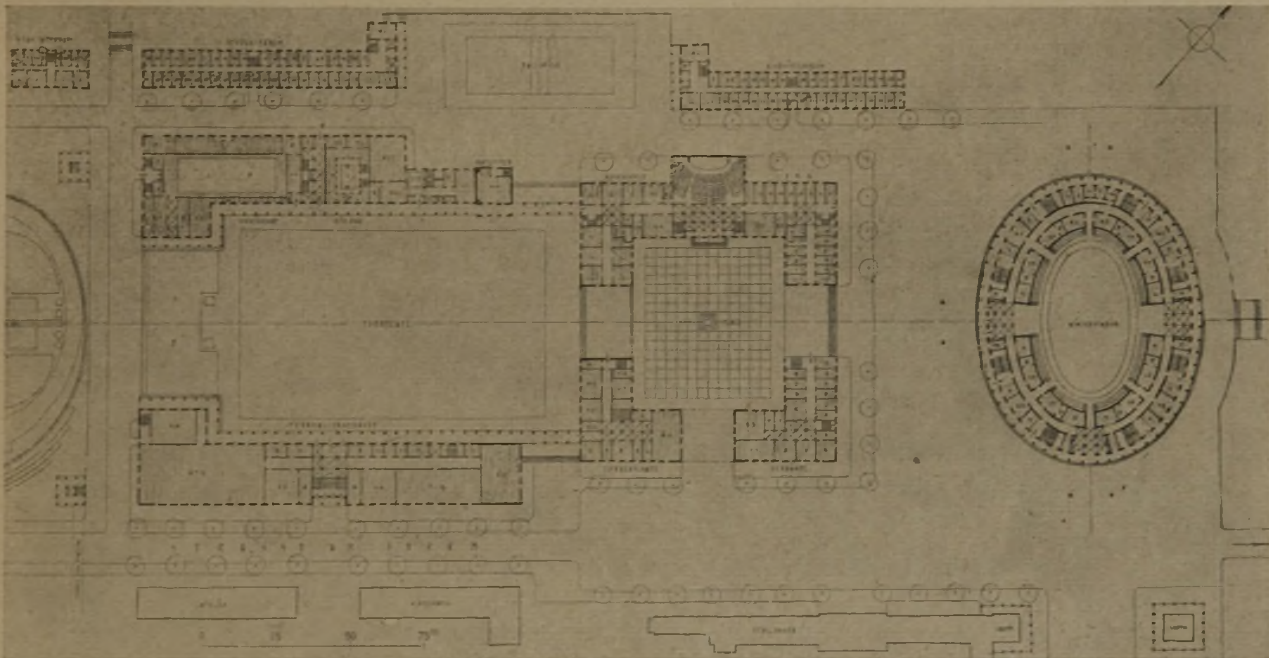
Grundriß der Hauptbauten auf dem östlichen Geländeteil. (1 : 4000.)
